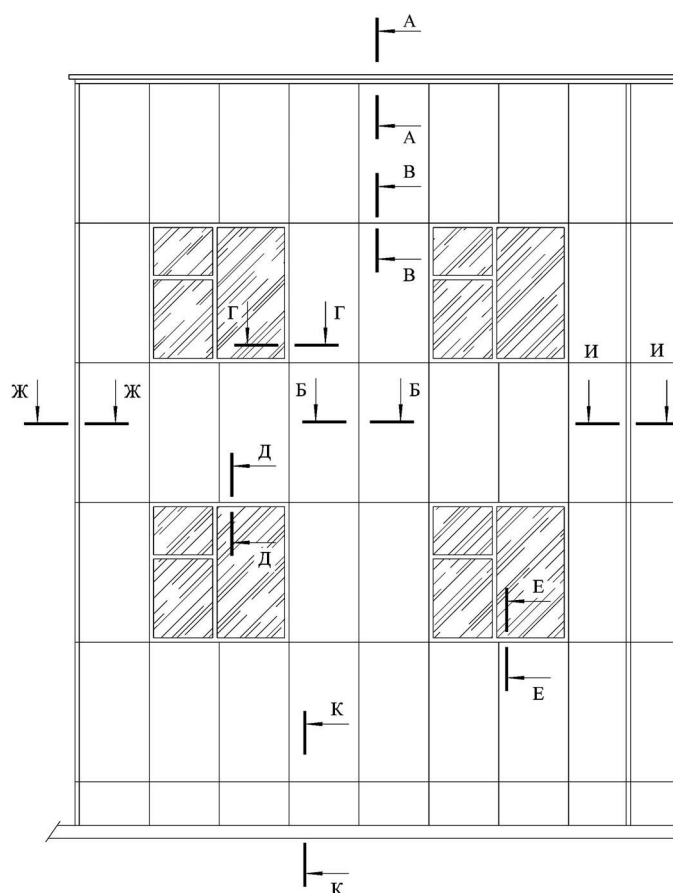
Фрагмент здания с навесной фасадной системой с воздушным зазором (вентфасад)
